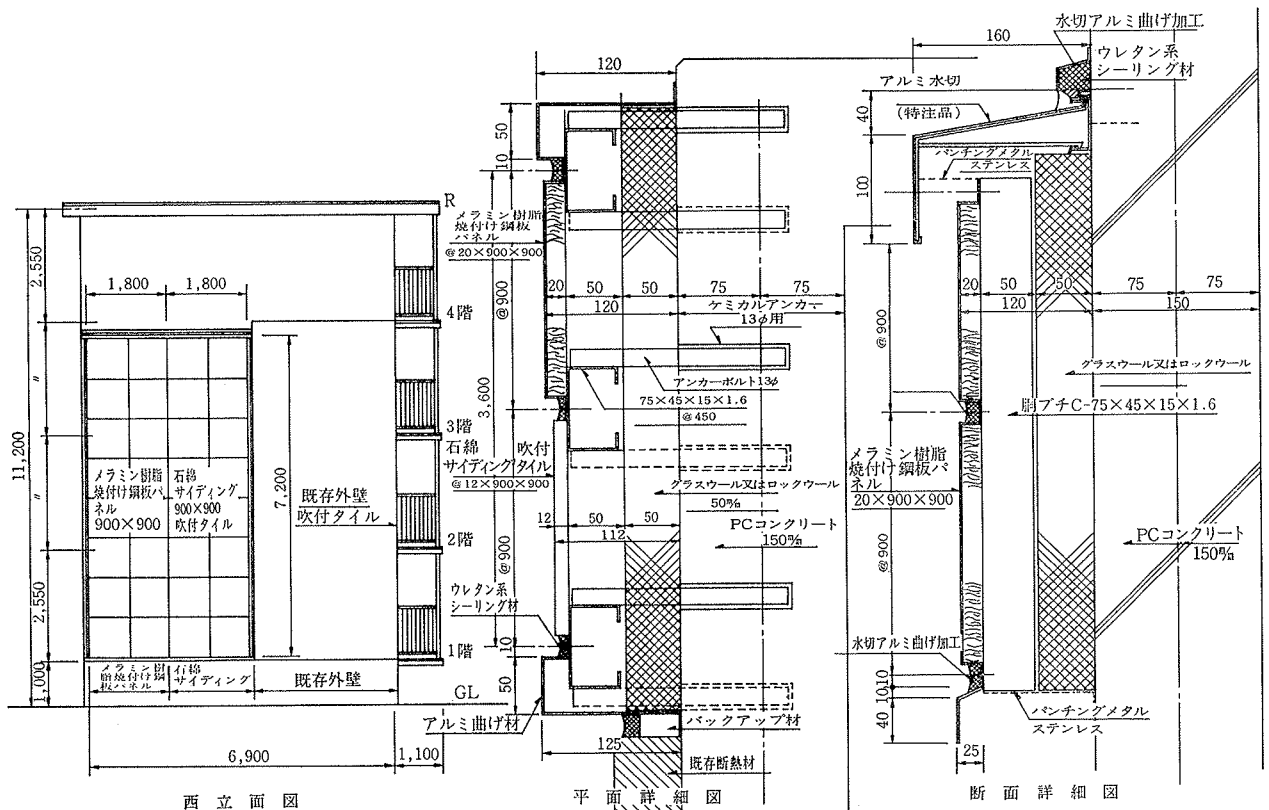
通気層のある外断熱試験工事の立面・平面・断面図
